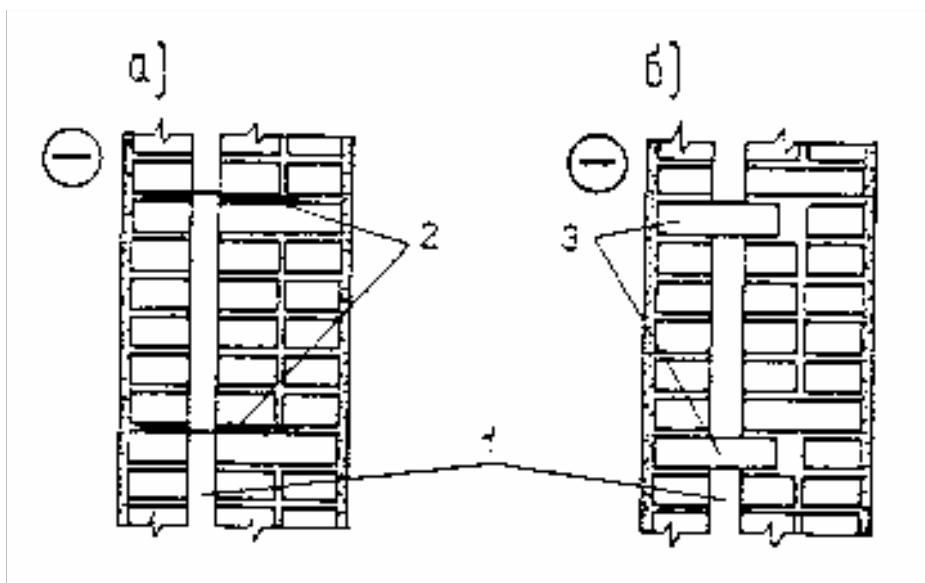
Кирпичные стены с воздушными прослойками:
